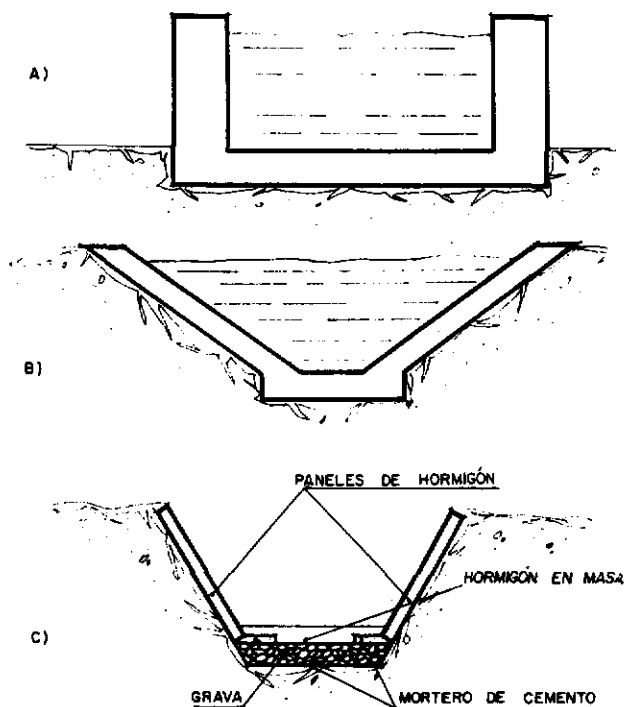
A) Acequia con la base apoyada sobre el terreno. B) Acequia con base y muros apoyados sobre el terreno. C) Acequia con base y muros apoyados sobre el terreno, construida con revestimiento de bloques prefabricados de hormigón.
